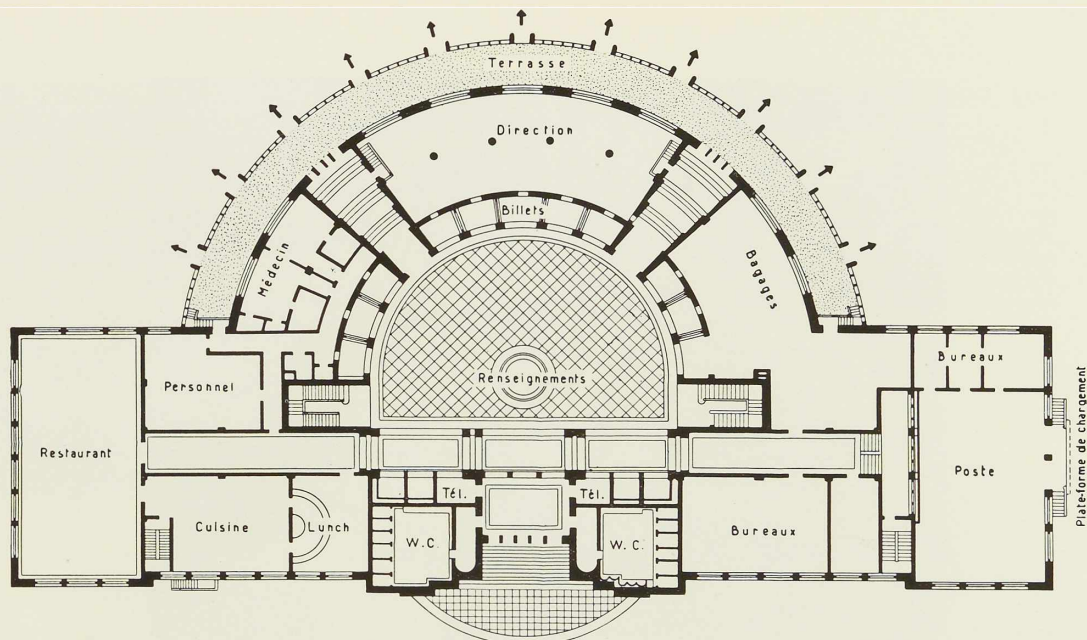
Plan du rez-de-chaussée du bâtiment des services administratifs de la base d'avions terrestres.
